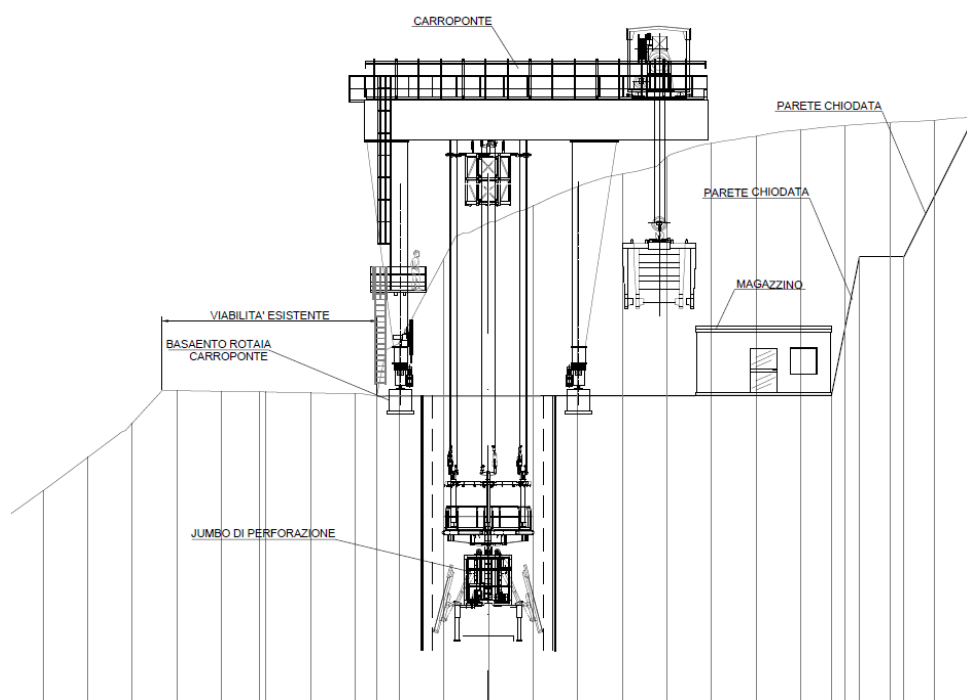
Cantiere pozzo: fase 2 – sezione in corrispondenza del pozzo e del carro ponte
